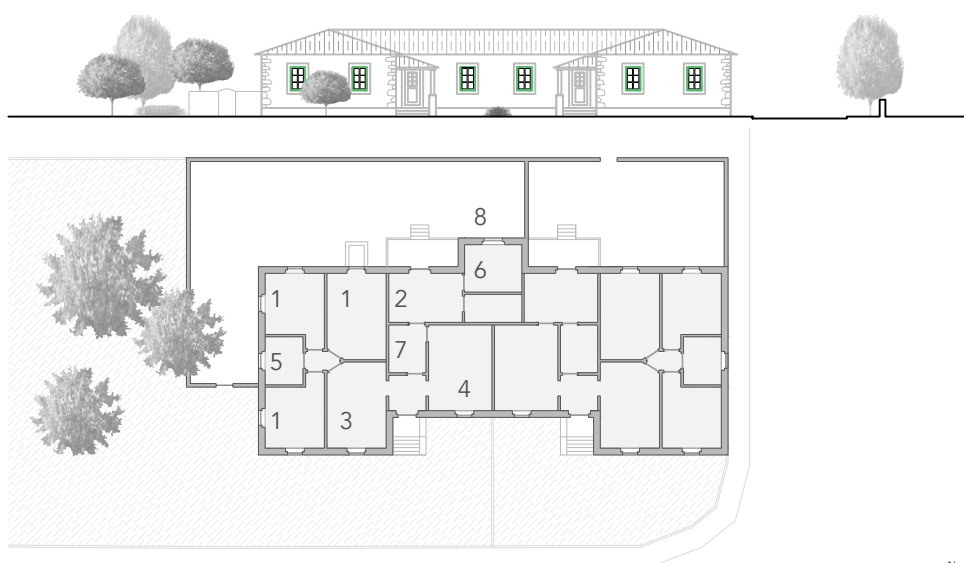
Planta e alçado principal das casas n.º 79 e 80
